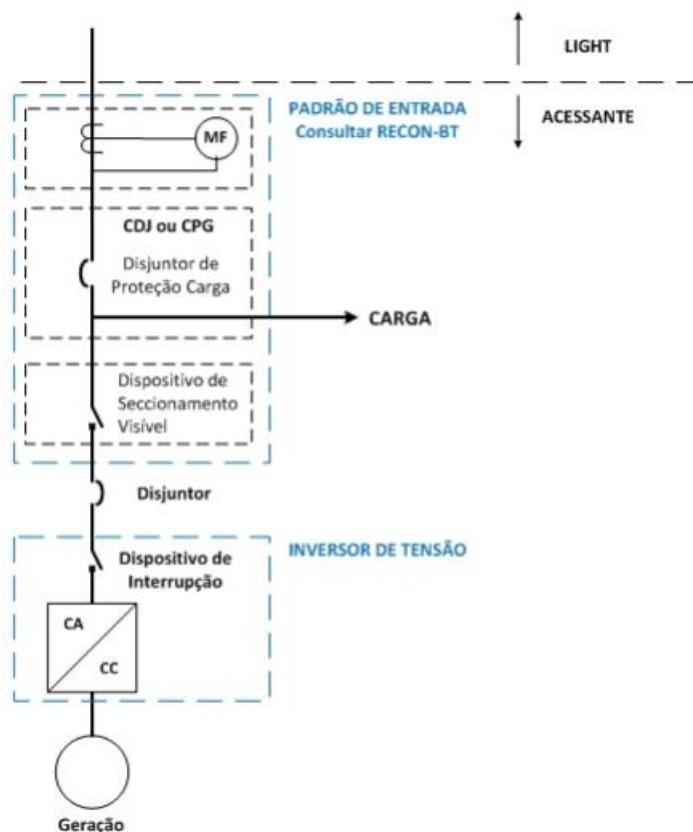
Esquema de ligação do acessante à rede BT da *Light
